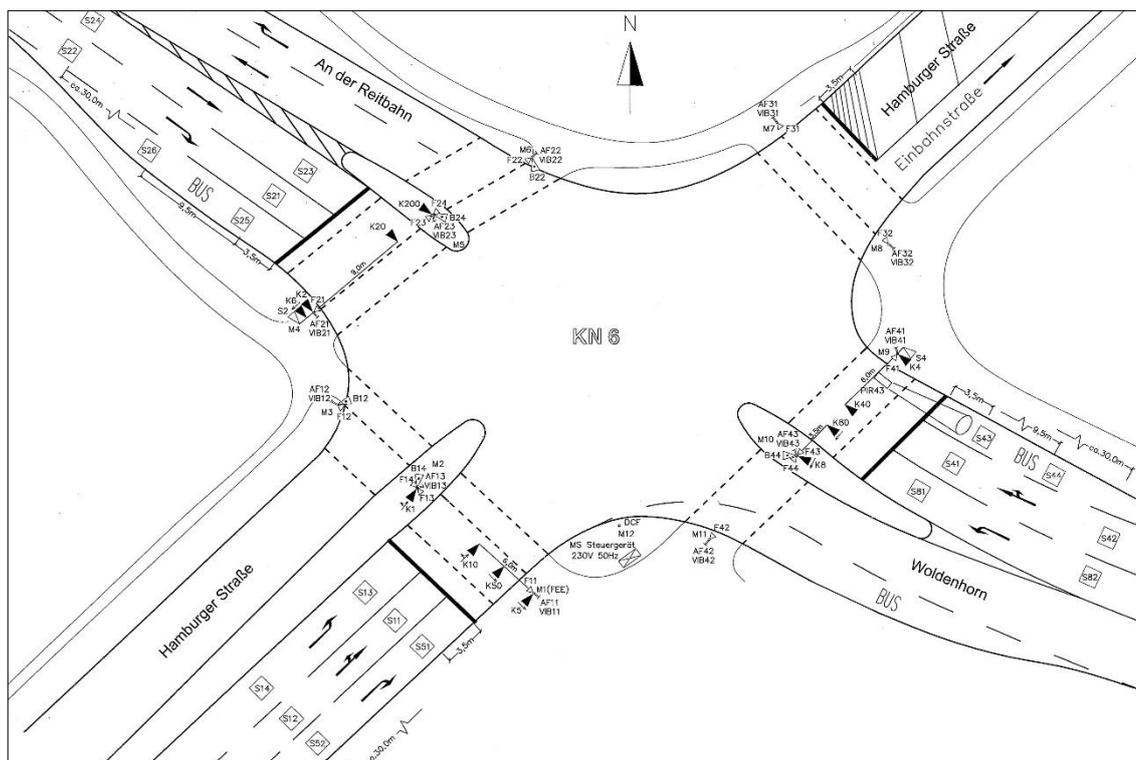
AOK-Knotenpunkt – Signallageplan
